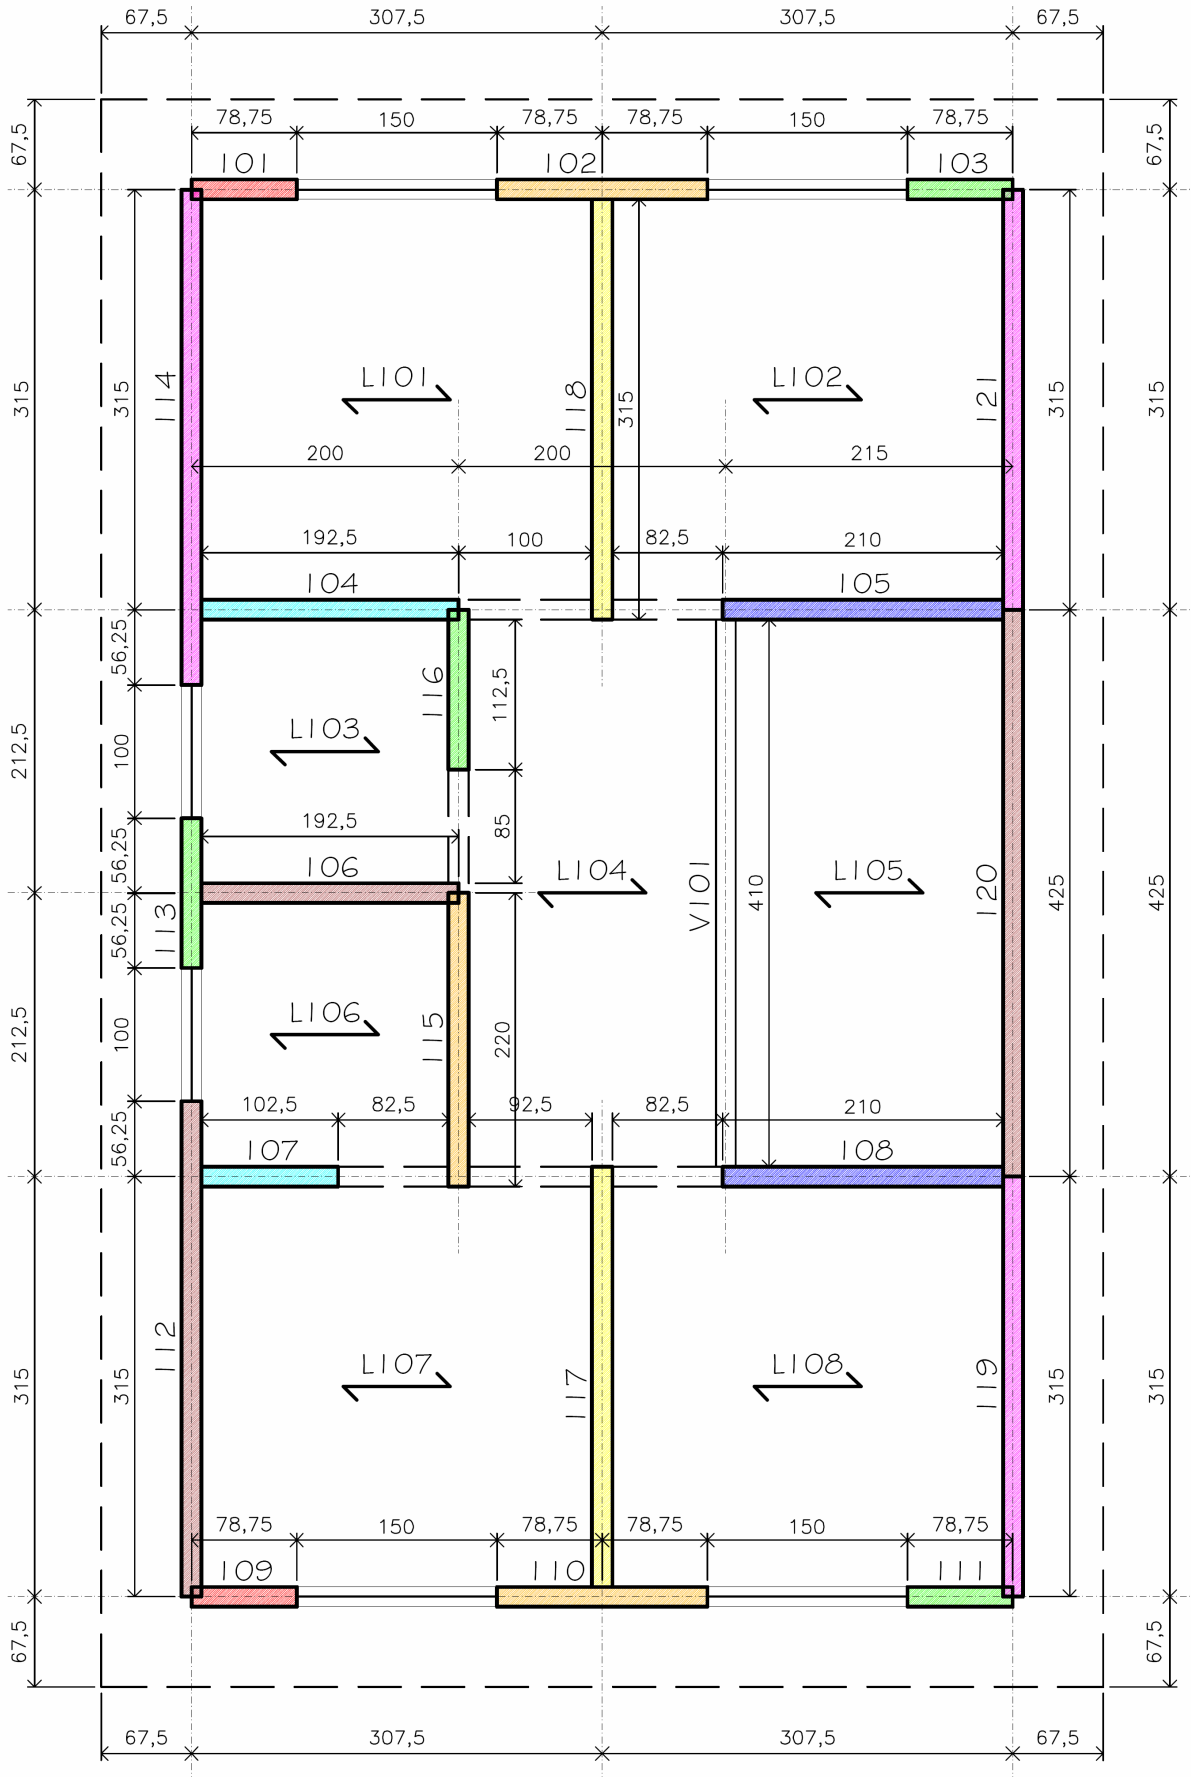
Estrutura do Exemplo K: pavimento superior
